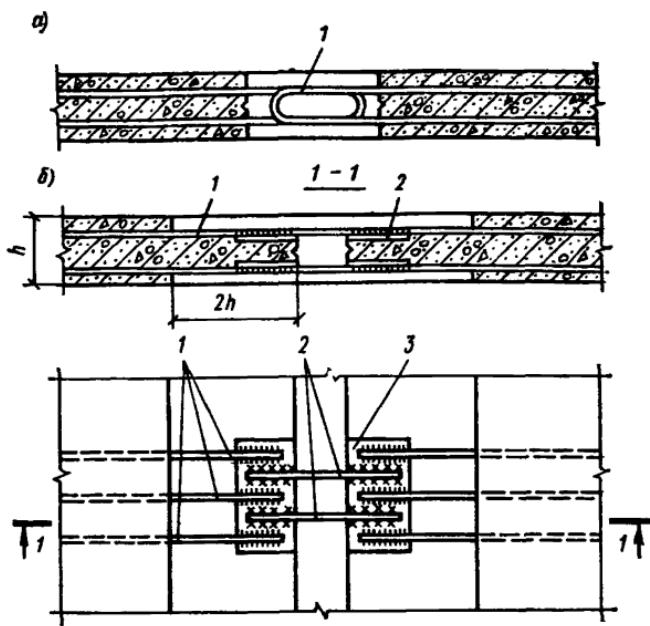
Соединение элементов самонапряженных железобетонных конструкций, работающих на растяжение (распределительная арматура и анкеры закладных деталей на рисунке не показаны)
